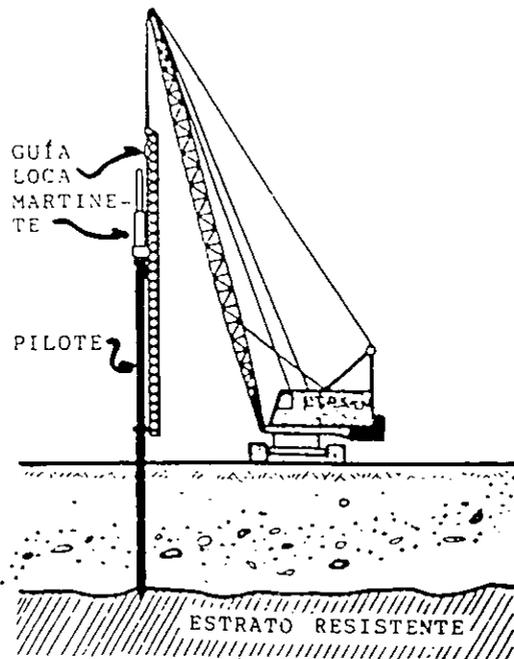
PILOTE HINCADO CON GUÍA COLGANTE.
